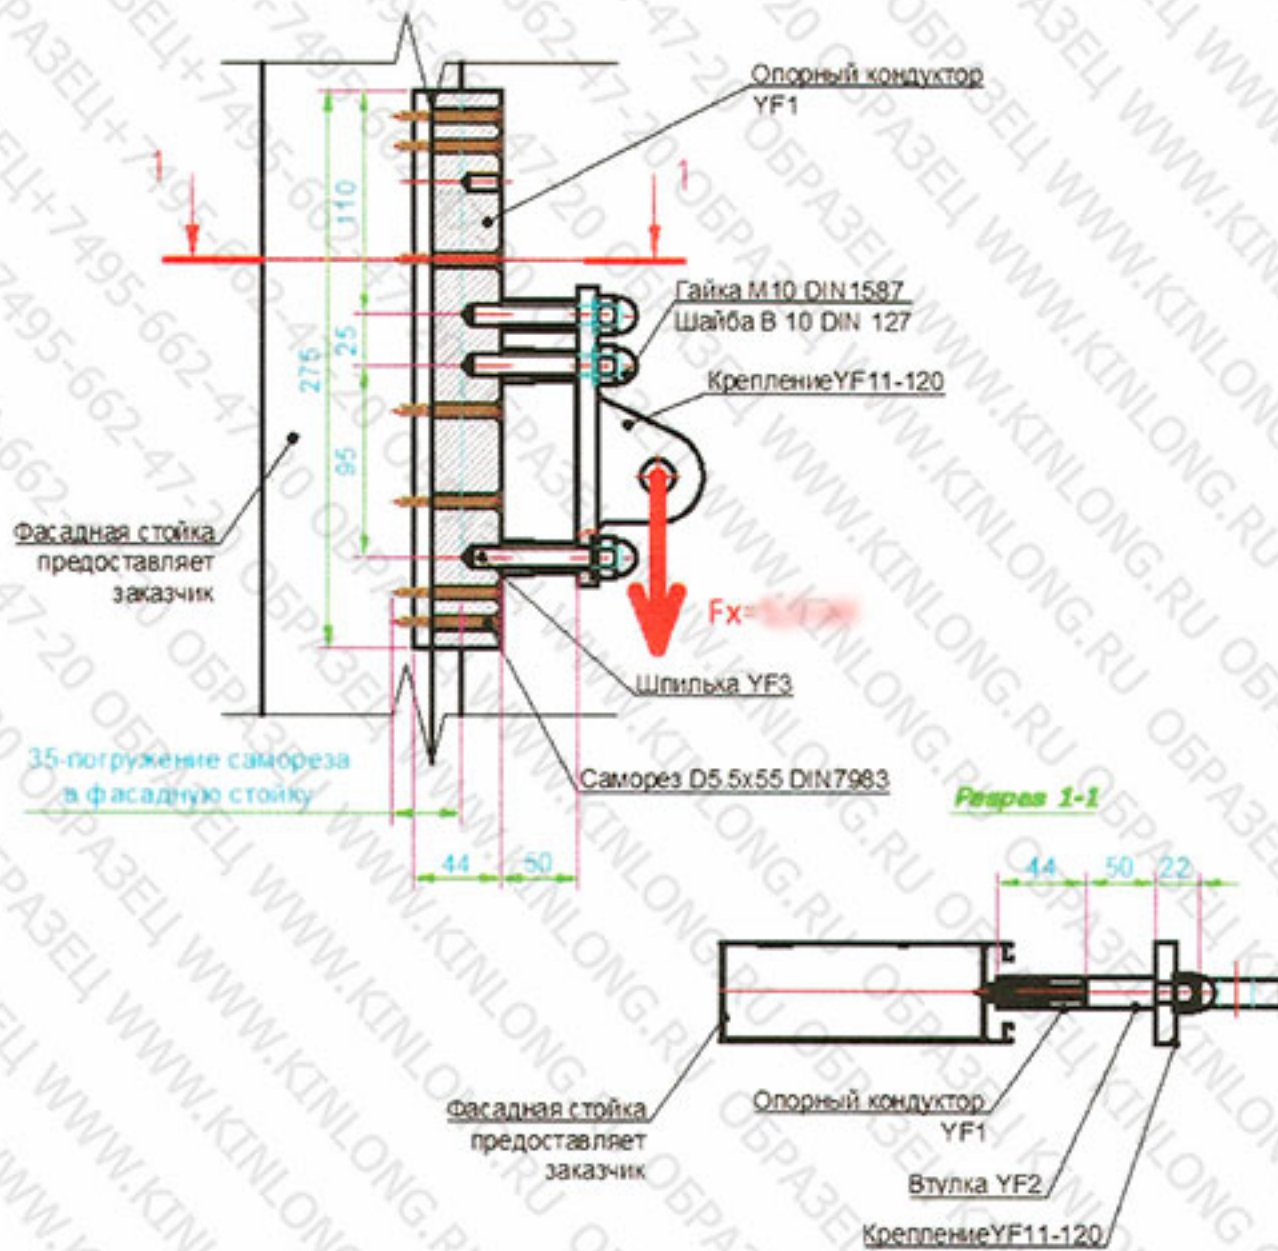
Опорный кондуктор YF1. Схема нагружения № 2
